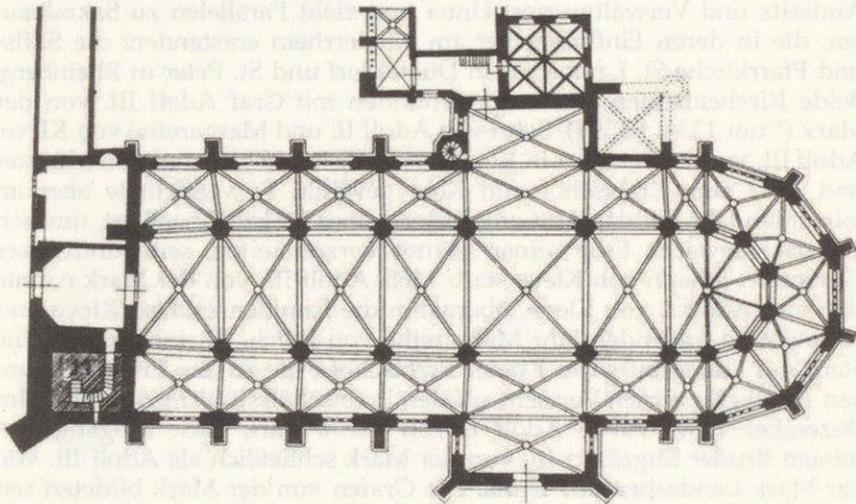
Verden (Aller). Grundriss der ehemaligen Domkirche mit Hallenumgangschor
